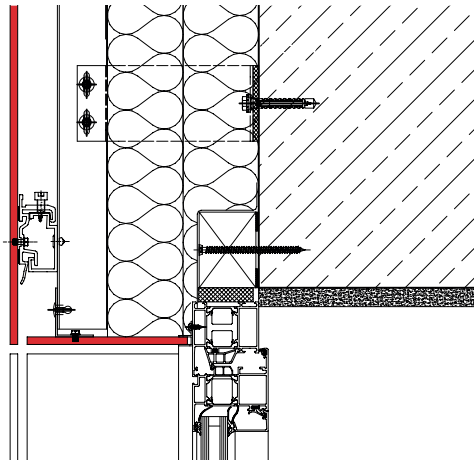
DETAILS VERDECKTE BEFESTIGUNG AUF METALLUNTERKONSTRUKTION
